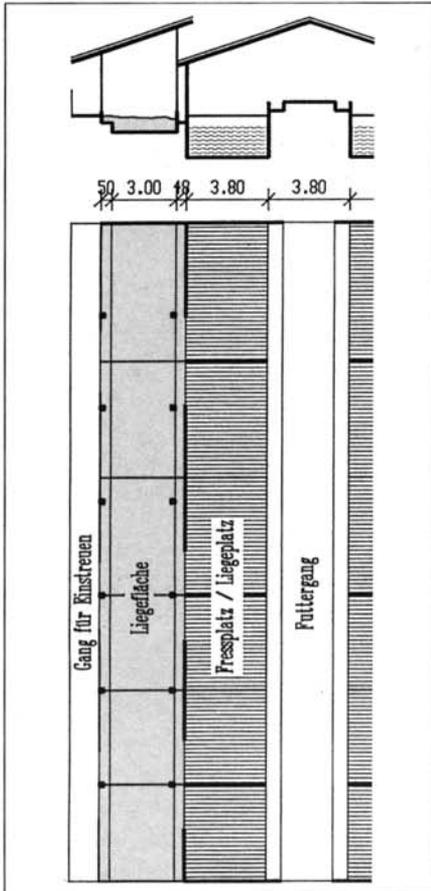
Grundriss und Querschnitt der Lösung Gutsbetrieb Wauwilermoos.
